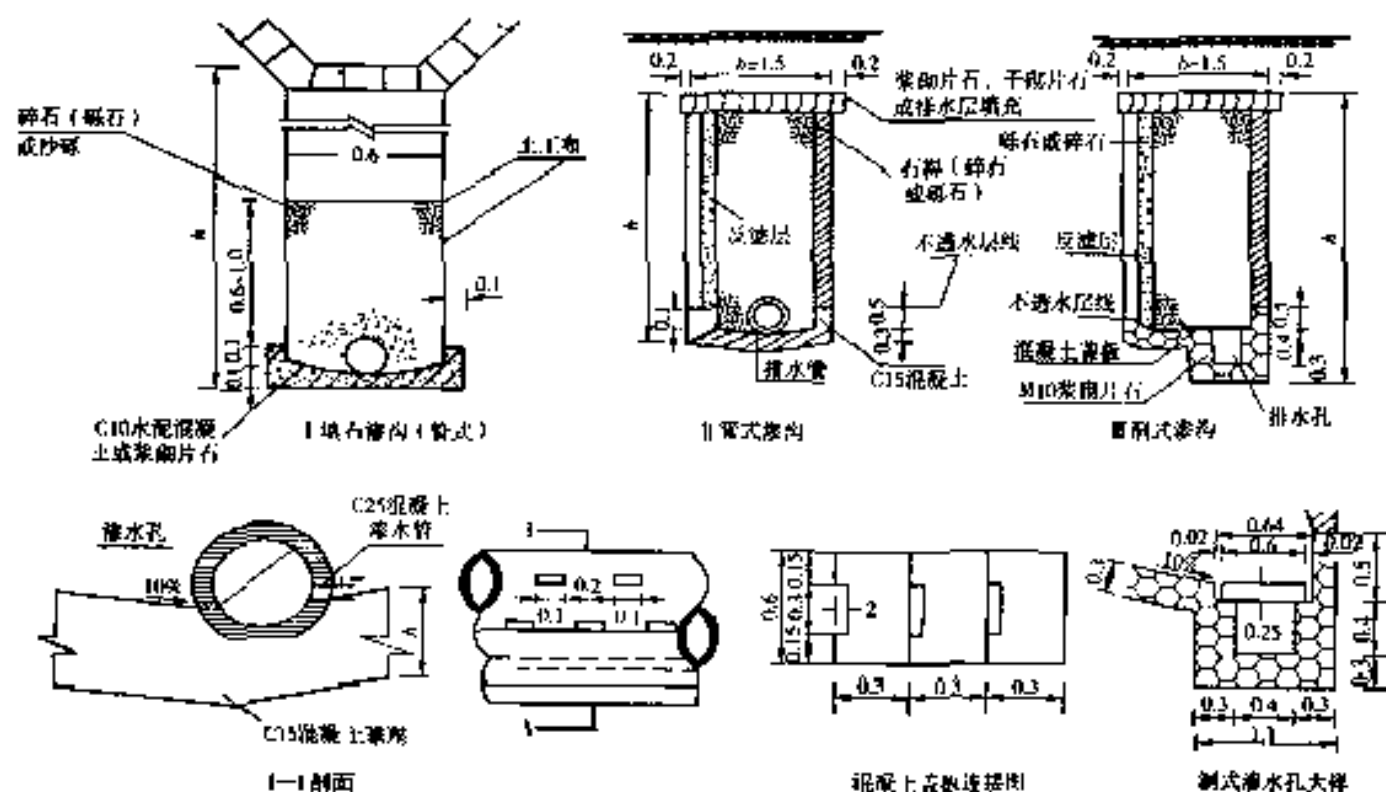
渗沟构造图(尺寸单位:m)
